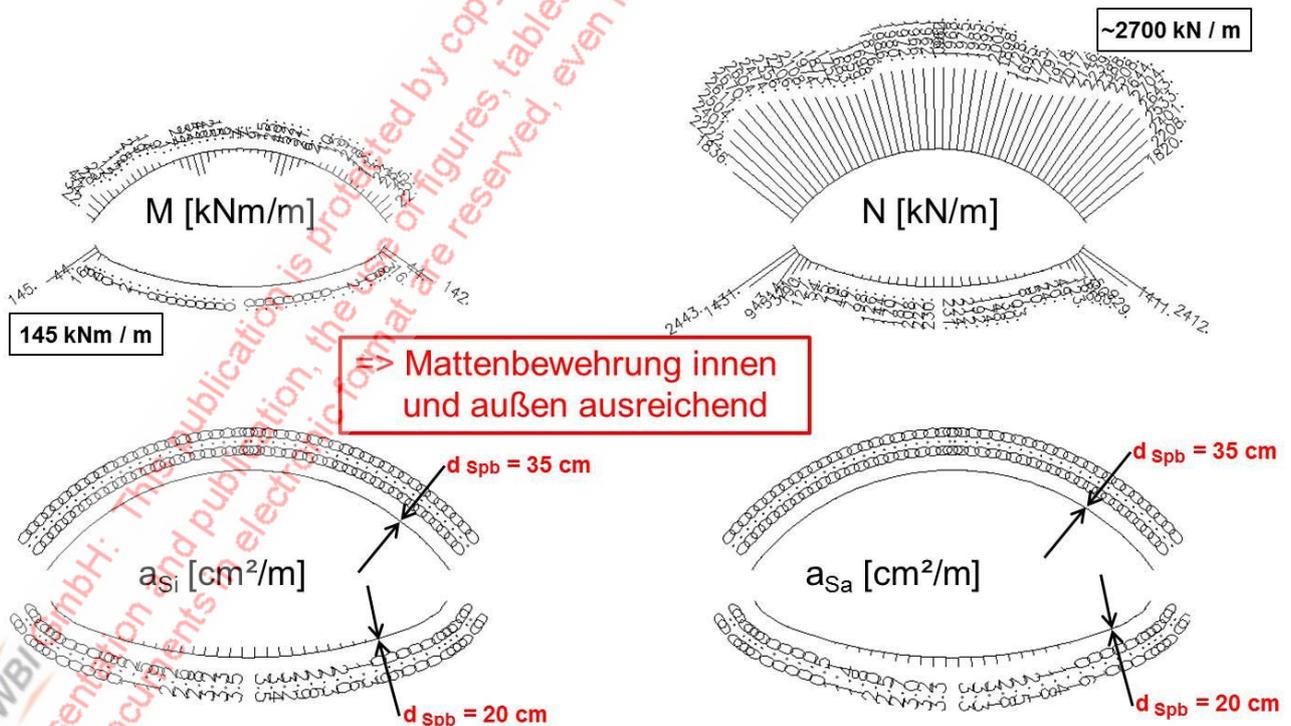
Schnittgrößen und Bemessung Spritzbetonschale nach Ausbruch und Sicherung Kalotte (Rechenschritt 3)
